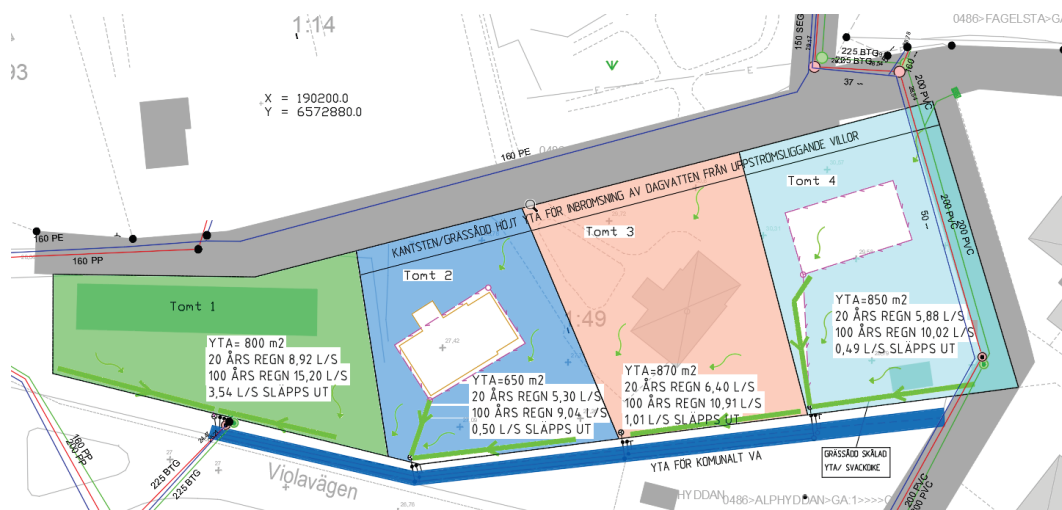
Bilaga, dagvattenplan, Feron Construction AB, 2020-11-10 Källa: Dagvattenutredning, Feron Construction AB
